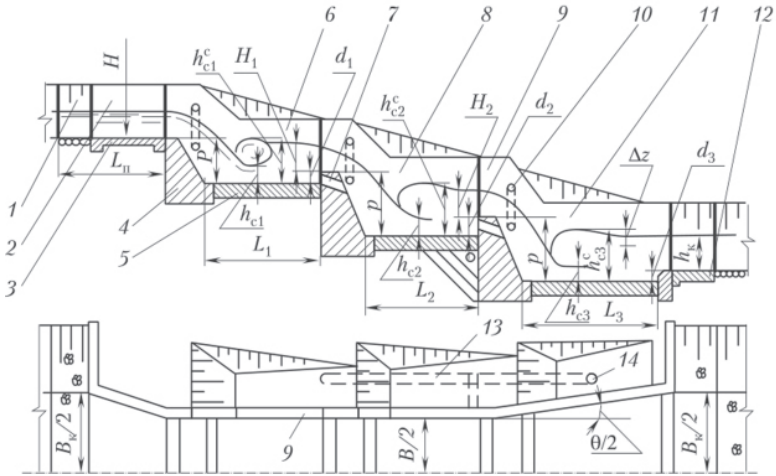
Rápida escalonada: planta y corte longitudinal.
